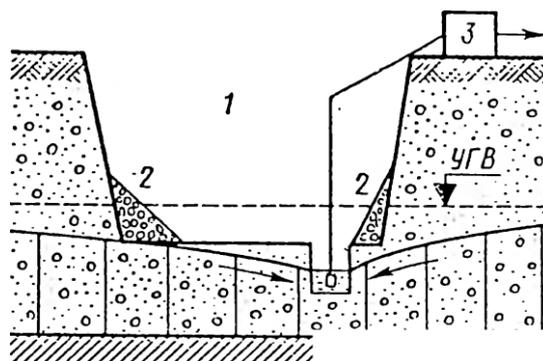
Открытый водоотлив: 1 - котлован; 2 - пригрузка откосов; 3 - насос
